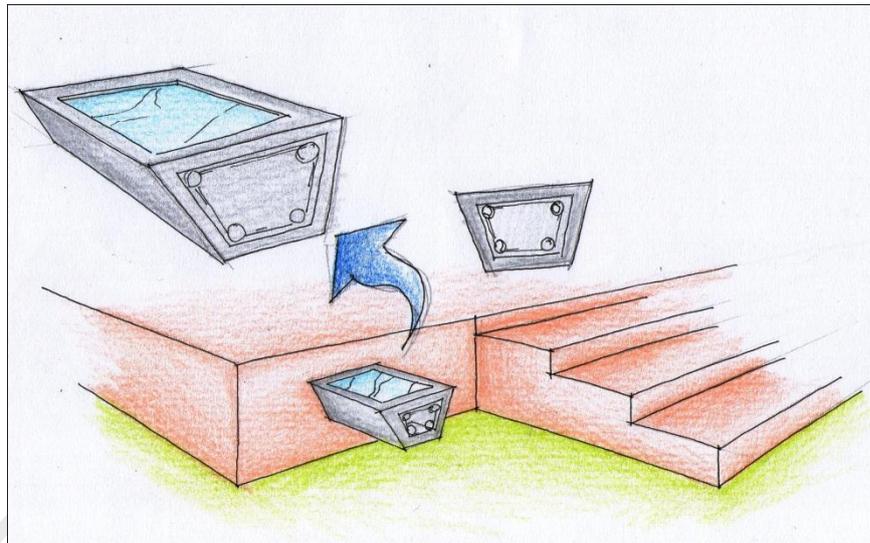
Detail Arsitektur Kolom Bangunan
